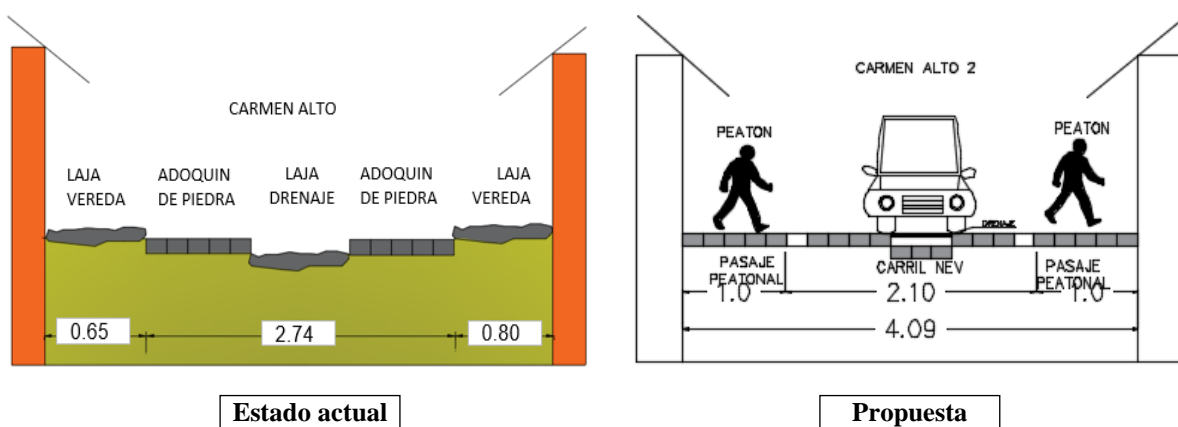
Propuesta de la sección transversal para la calle Carmen Alto 2
